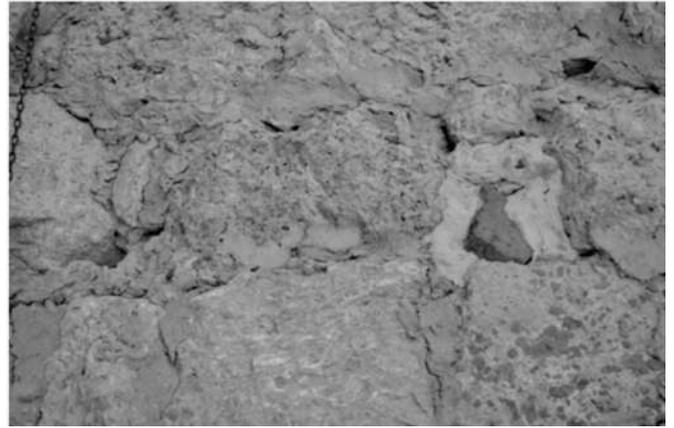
Detalle del muro. Se observa la construcción de los muros con bloques de piedra.
